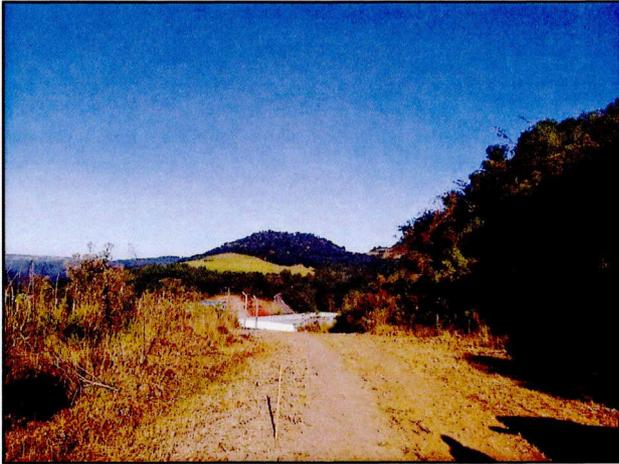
vista sul do leito da Rua existente a ser regularizada, conforme ponto 02 do projeto;
